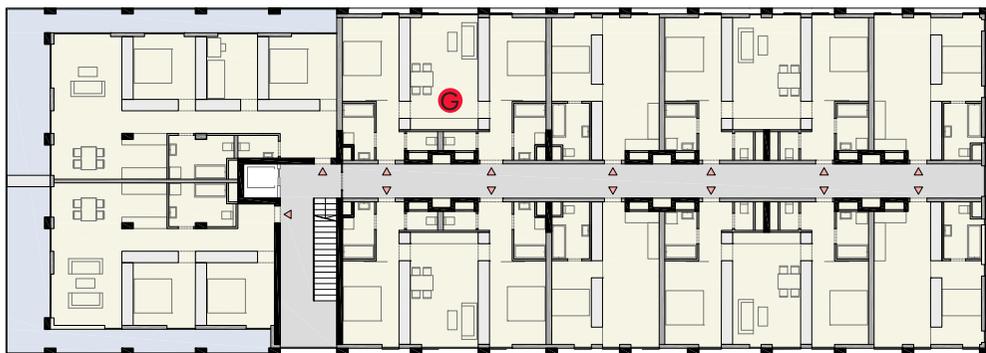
GR 1. Obergeschoß M 1:400 Typ G: Grundrissfariabilität, siehe auch Abb. 109
